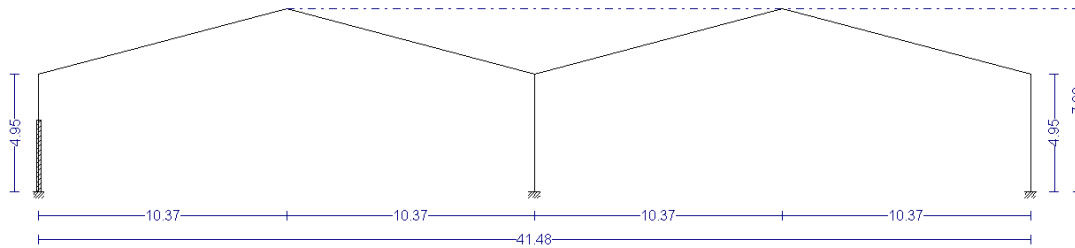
Distribución de pórticos de fachada e intermedios en hormigón
